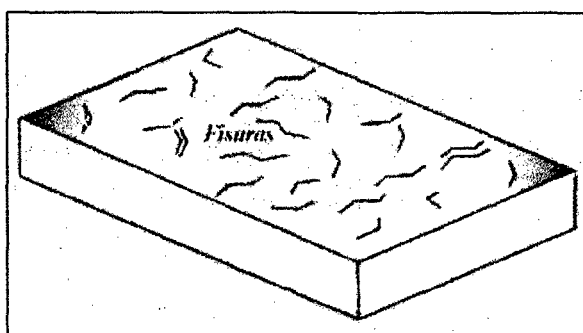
15. Fisuras distribuidas aleatoriamente en la cara superior de losas debido a la retracción plástica del concreto. Fuente: (Stuardo P., 2008)
